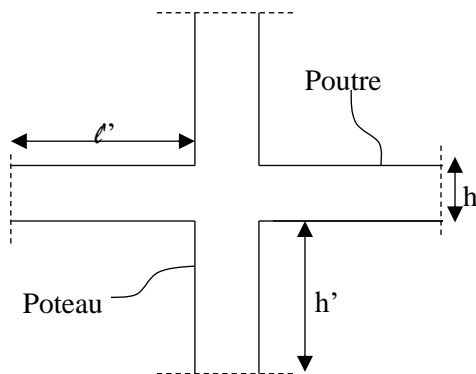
Zone nodale (nœud poutre-poteaux)
